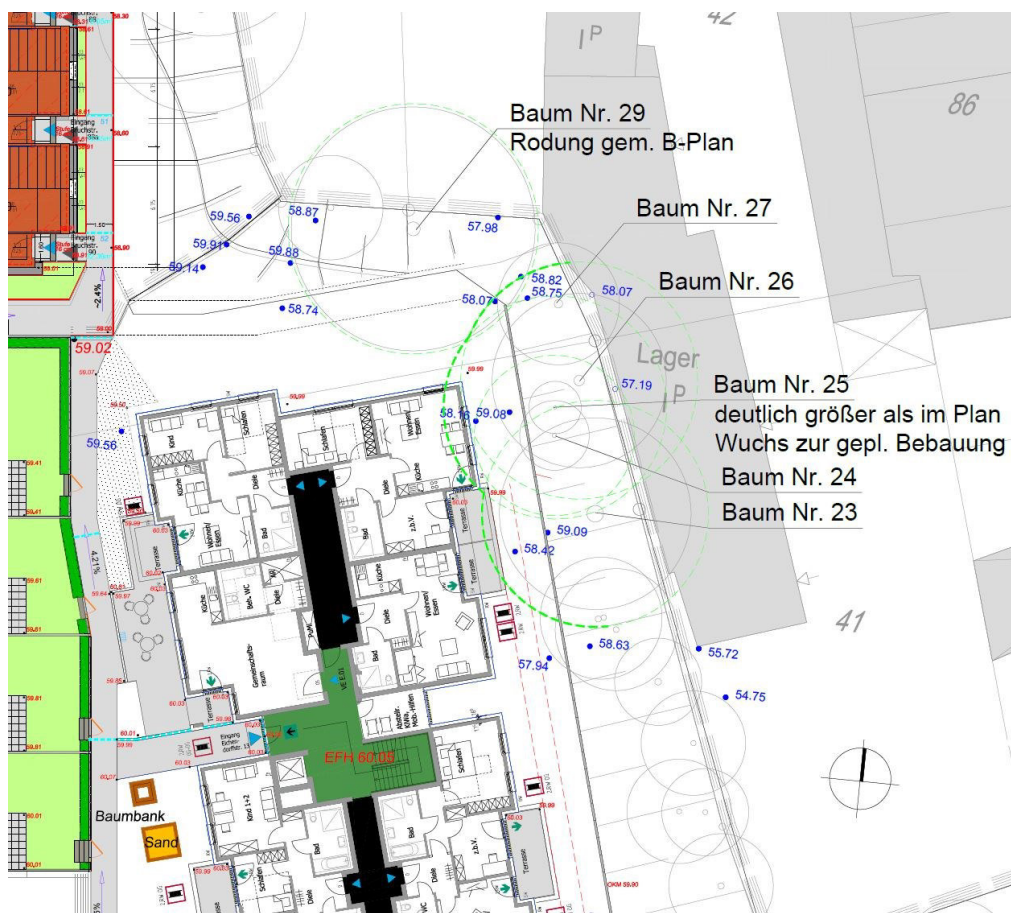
Auszug aus Entwurf Lageplan „FREIANLAGEN“ (Stand 16.11.2023)
